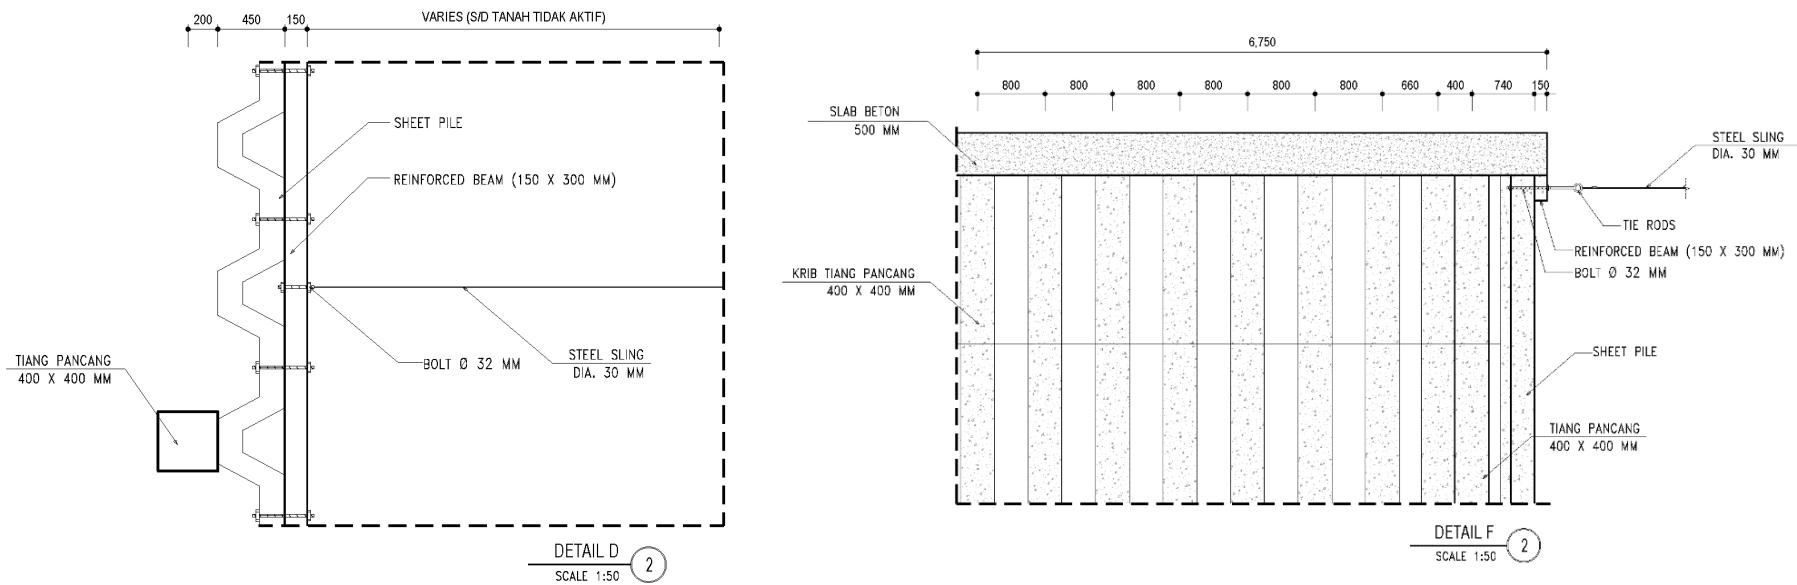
Layout Parsial Alternatif 3 Sheetpile
